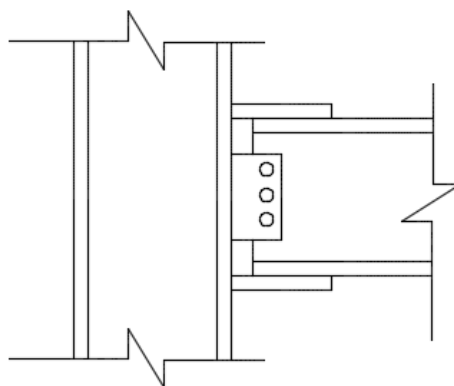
Conexión a momento tipo Placa soldada – Alma empernada, de viga a columna.
